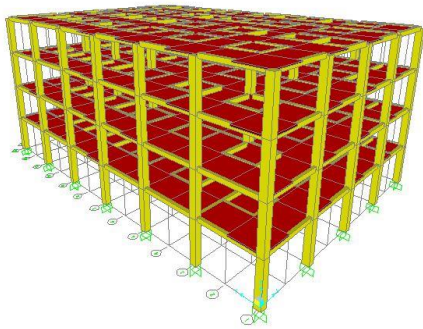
Denah bangunan untuk gedung 1 dan gedung 2
